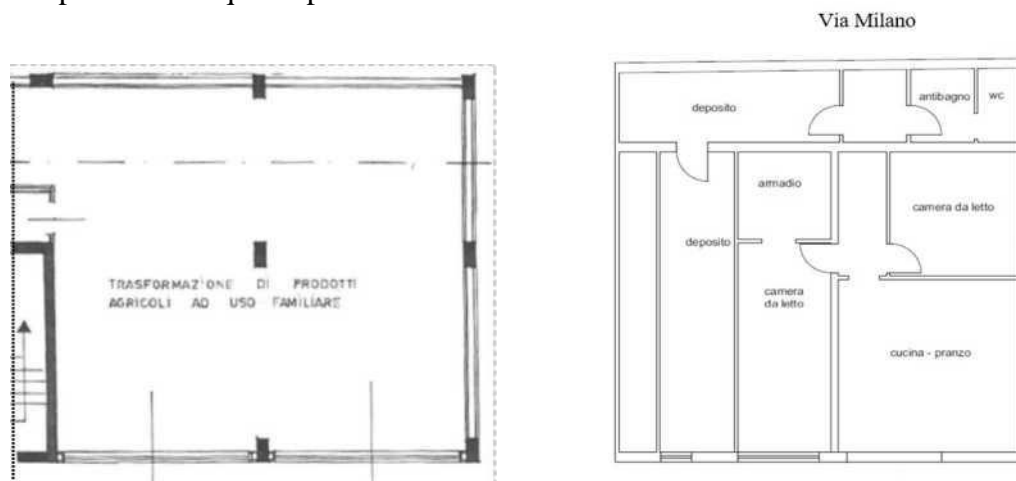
Piano terra sub 3 (il piano risulta seminterrato) - Confronto tra la planimetria “assentita” e stato di fatto.
